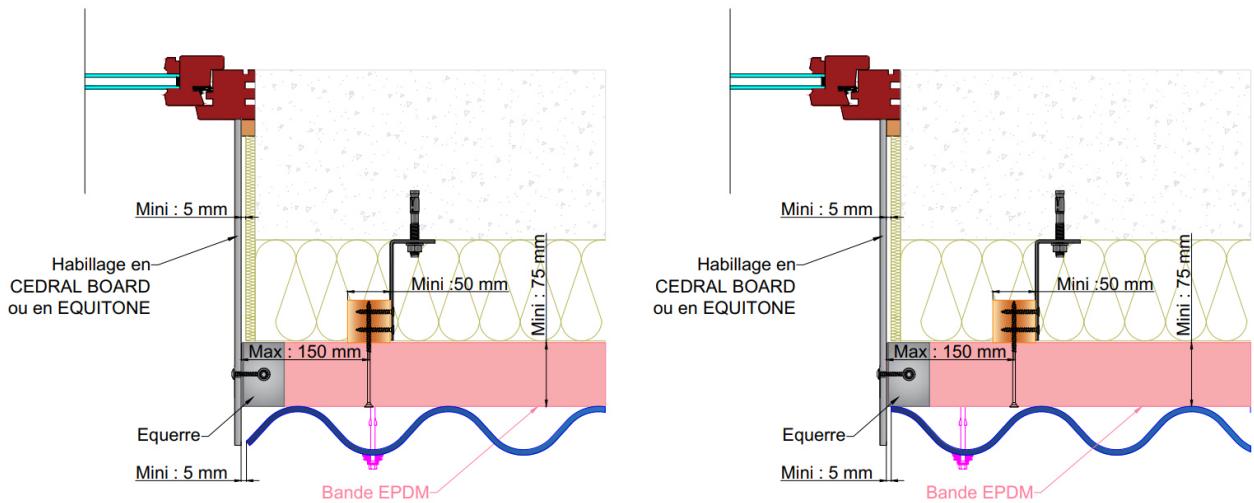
Tableau de baie avec panneau CEDRAL BOARD ou EQUITONE
